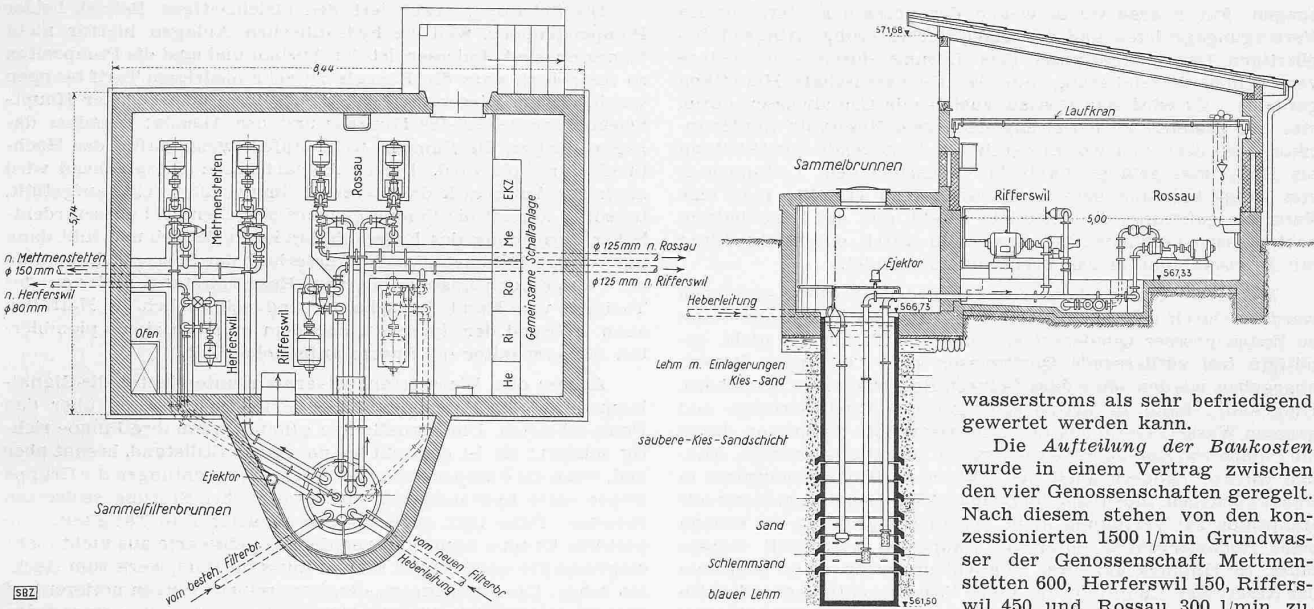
Grundriss und Schnitt durch das Pumpengebäude und den Sammelbrunnen bei Unter-Rifferswil. — Masstab 1 : 120
